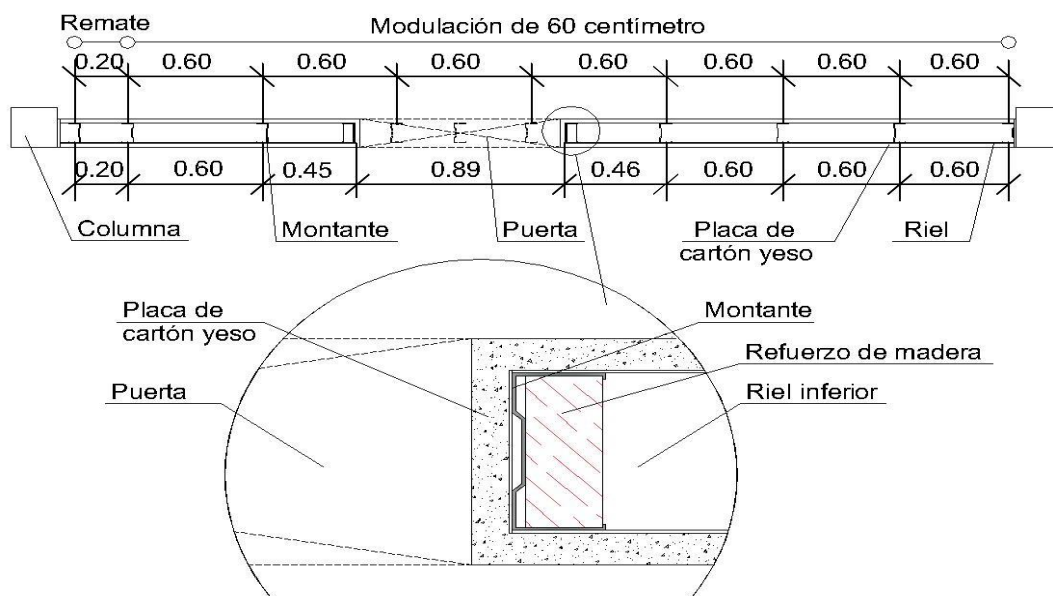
Vista en planta, modulación de los montantes en pared con puerta
